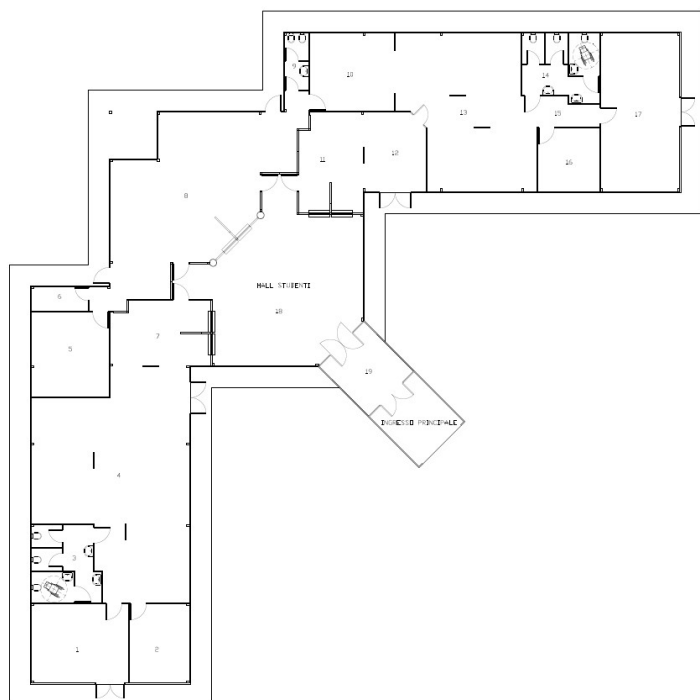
Pianta piano terra dell'edificio 1
